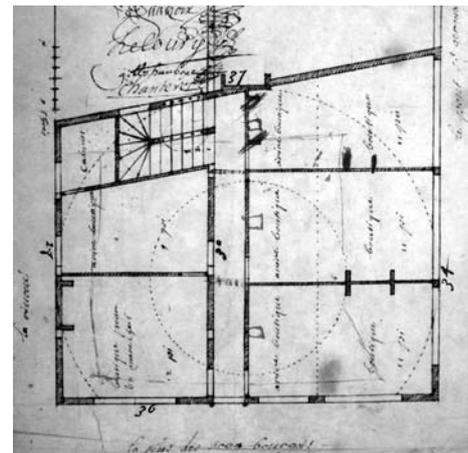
Plan d'une maison à construire sur l'emplacement d'une tour de la porte Saint-Germain. (A.D. Ille-et-Vilaine, 2G275/74)
